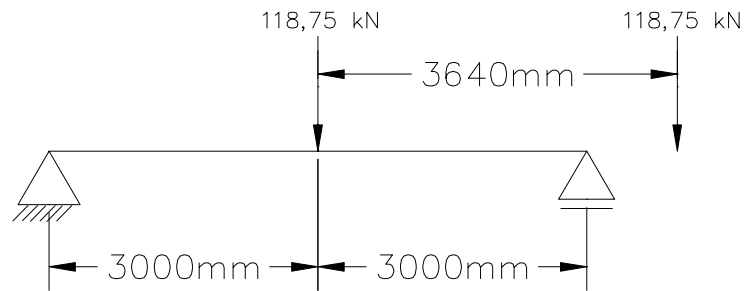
Posicionamento do trem tipo da ponte rolante sobre a viga de rolamento.
